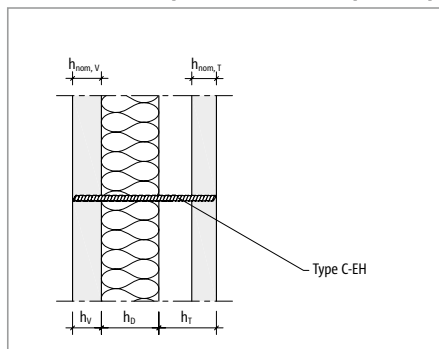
Schöck Isolink® type C-EH: données de la section du mur préfabriqué;  $h_{nom,V} = h_V$
